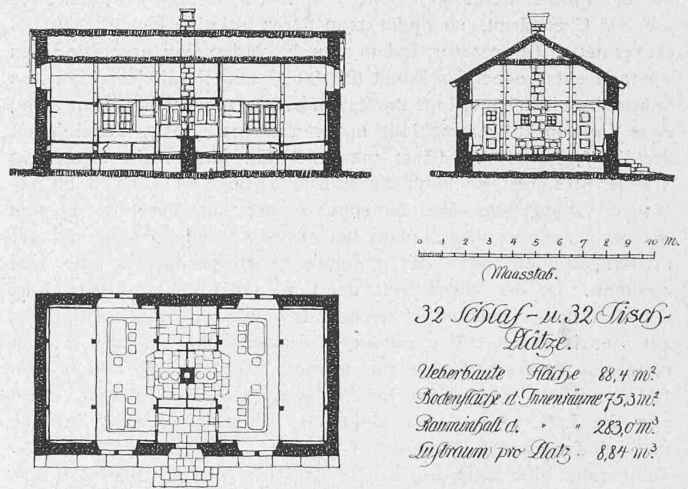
Grundriss und Schnitte der Cadlimo-Hütte. — Masstab 1 : 300.
